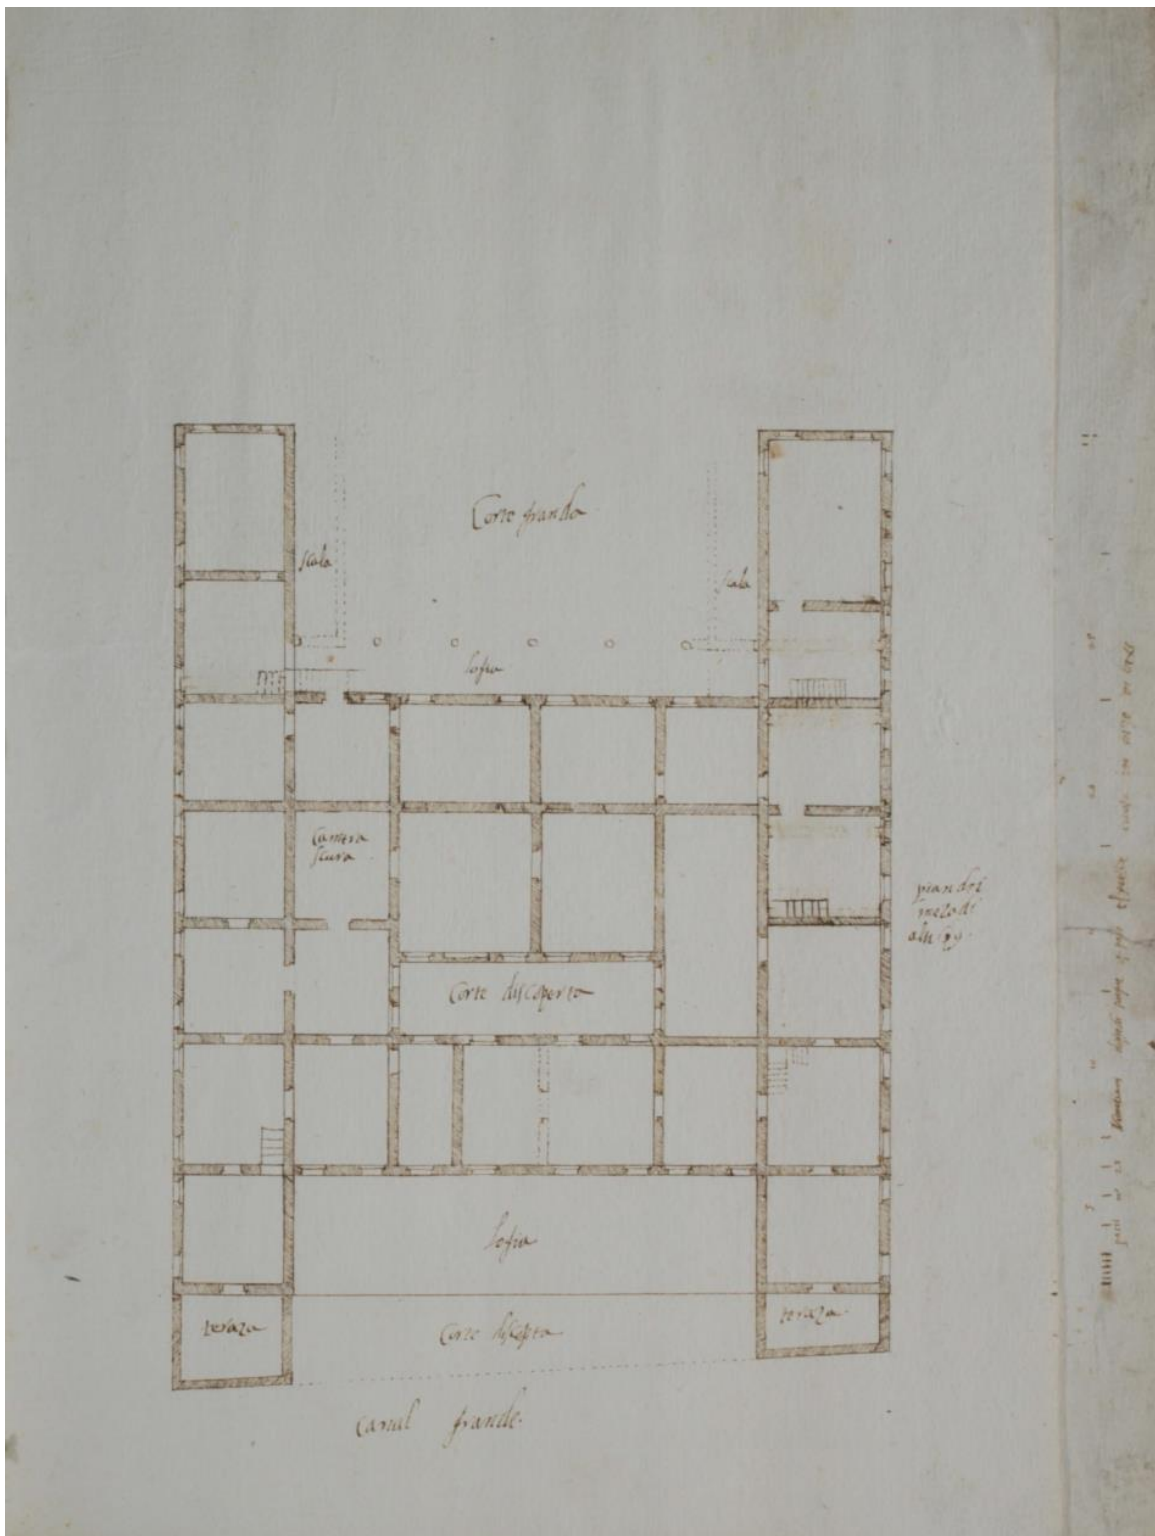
8 Cesare Torello, *Pianta del Palazzo già Pesaro poi dei Marchesi e Duchi d'Este* – mezzanine plan, ca. 1600.
